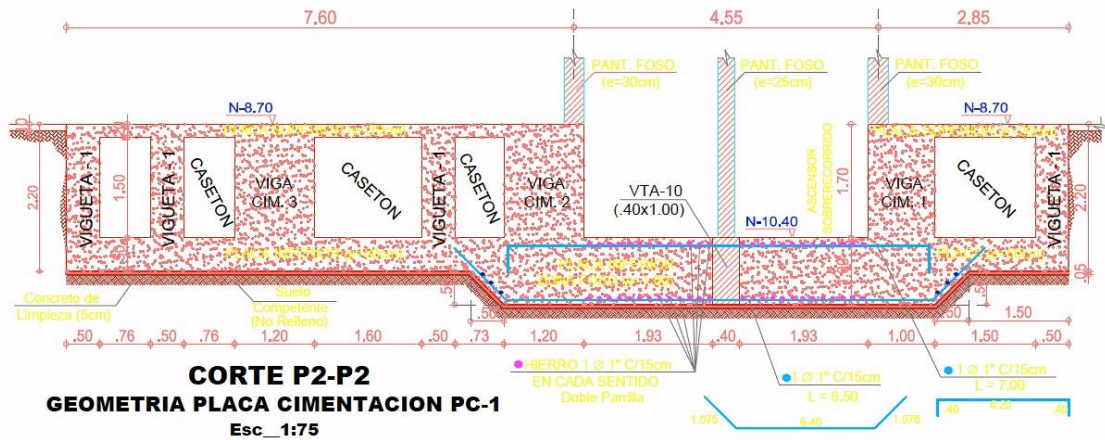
Corte transversal P2-P2, losa de cimentación PC-1.
